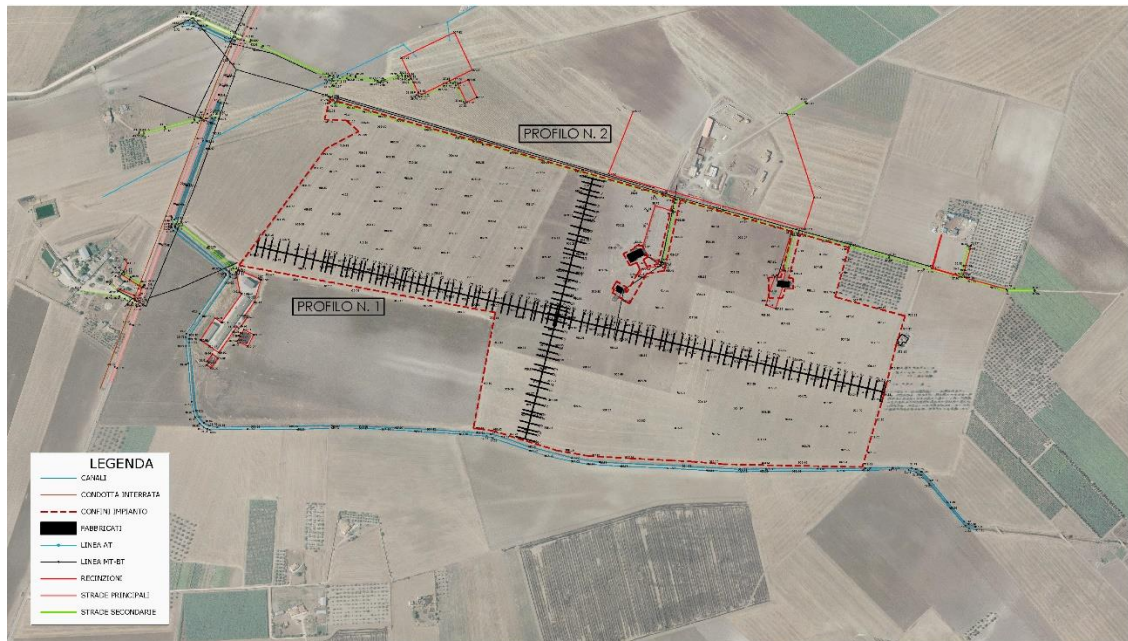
aree di progetto quotata su ortofoto e profili di sezione in magenta
